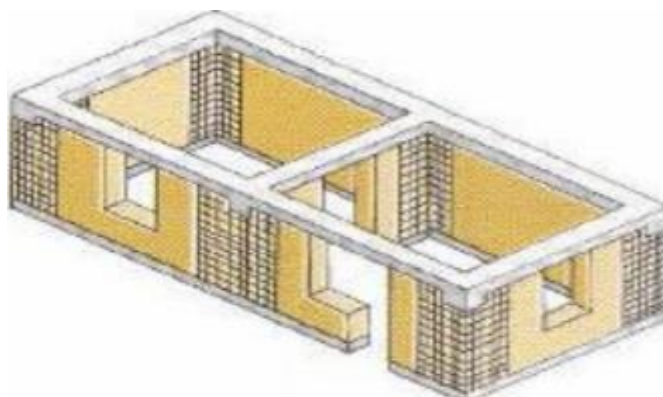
Viga collar de concreto armado (GTZ, COPASA, PUCP, 2005)
